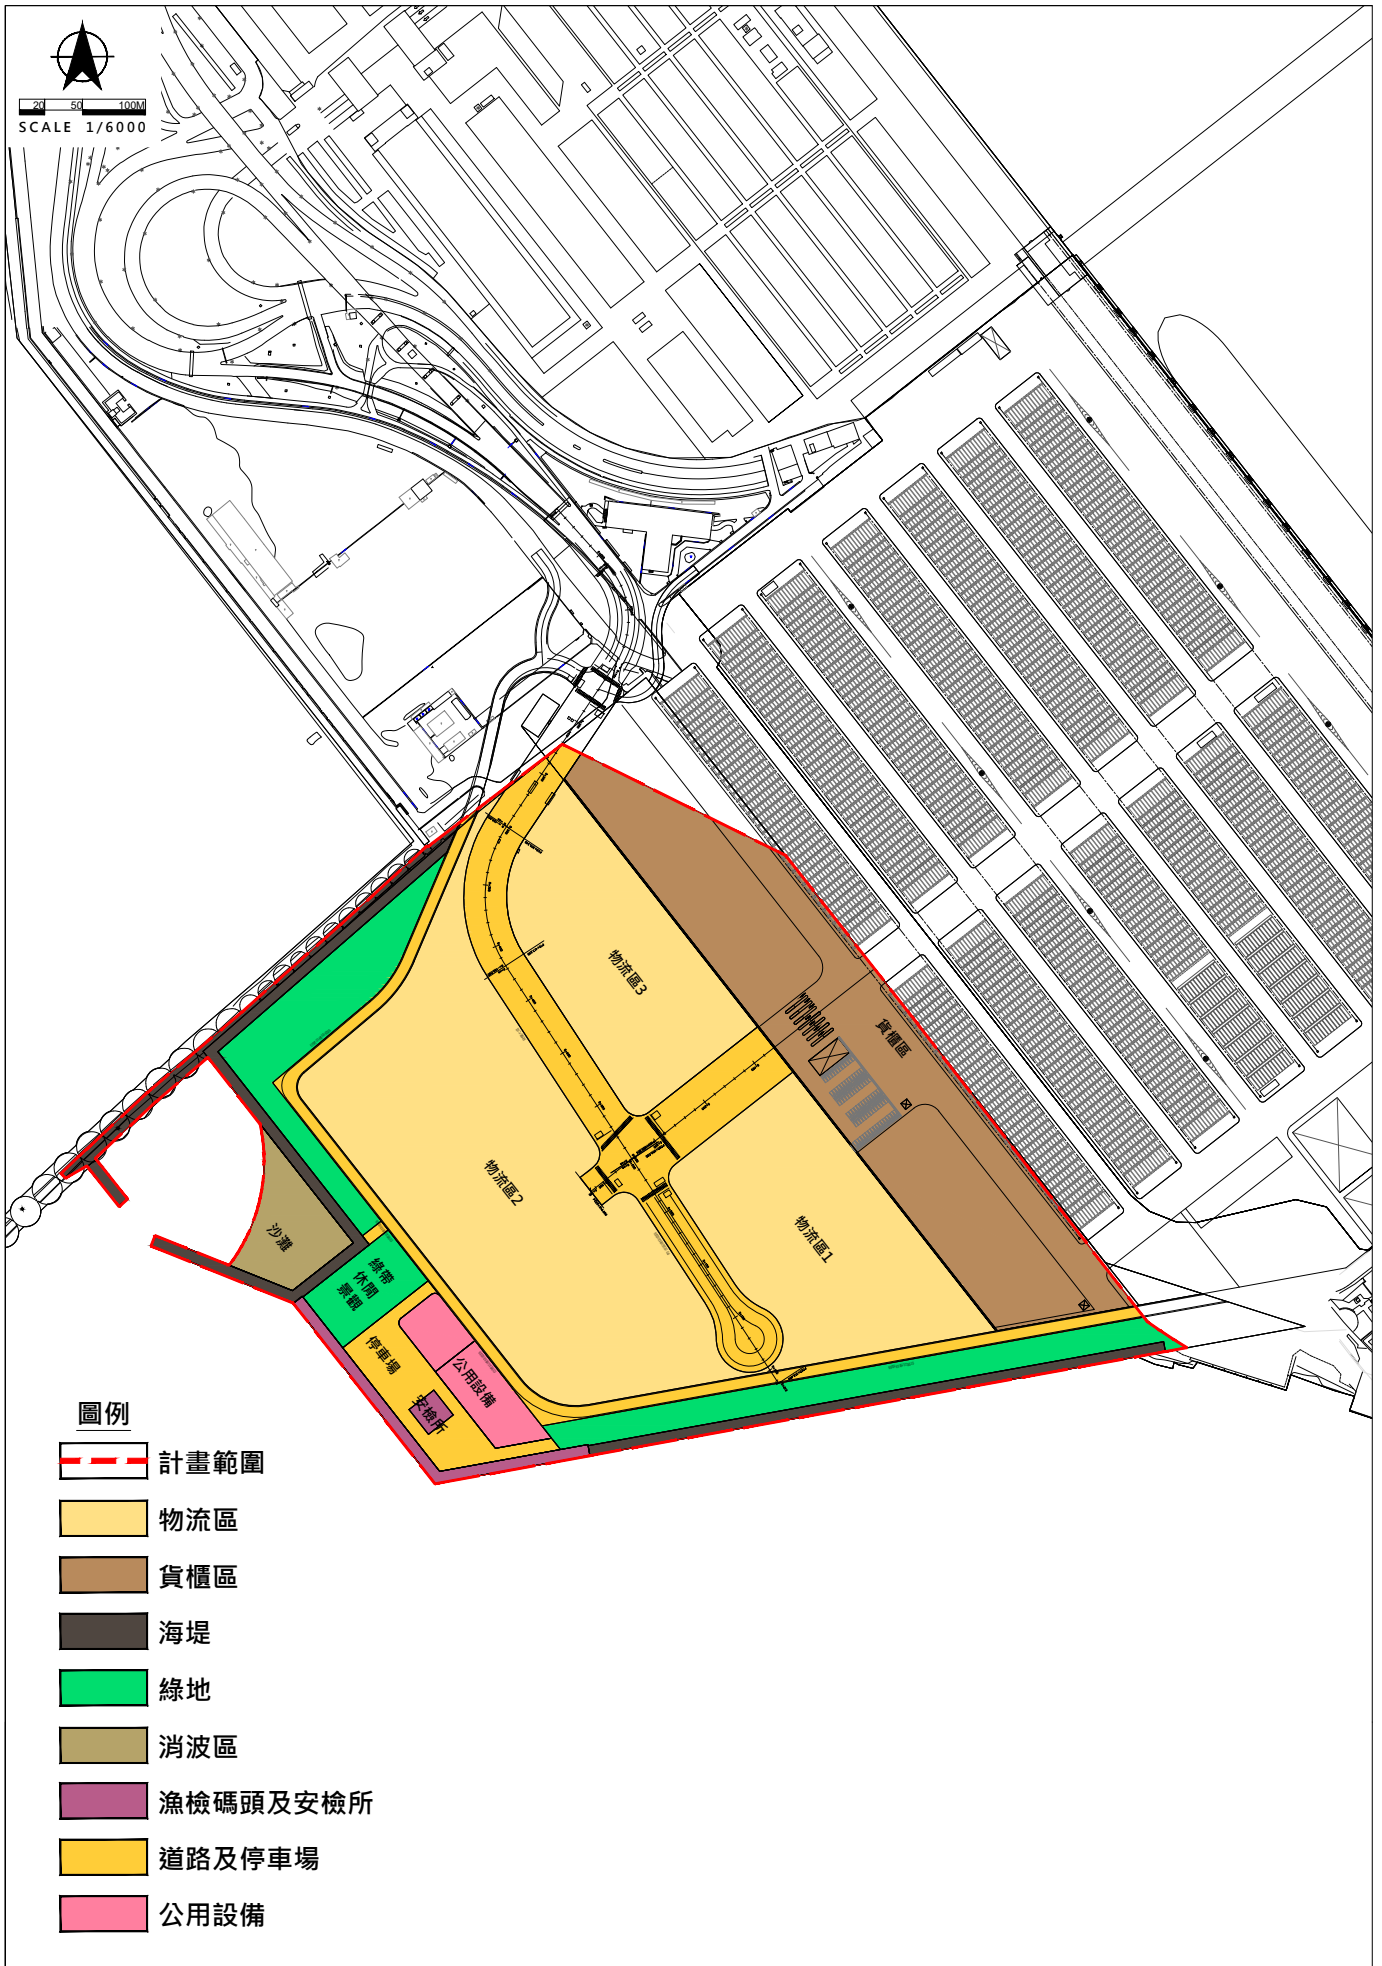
第四貨櫃中心後現場地擴建工程計畫平面配置圖
